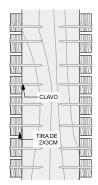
SOPORTE DE TIRILLAS REALIZADO PARA EL ENSAYO, FUENTE: AUTOR
